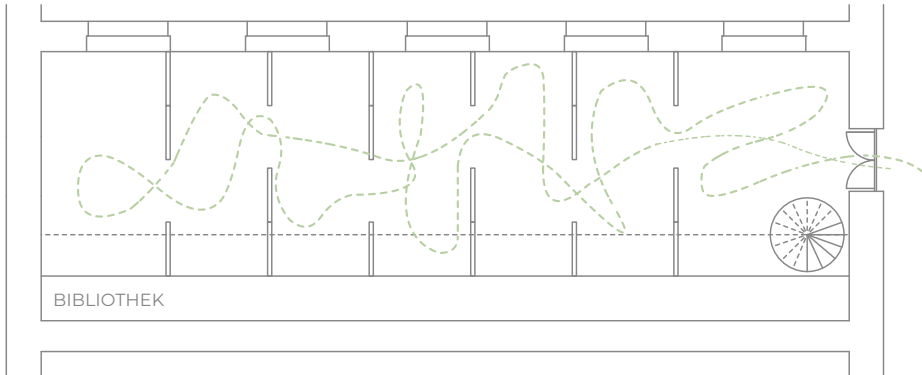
Adam Štěch: Elemente, *Ausstellungsrundriss*, MAK, Wien, 2024
